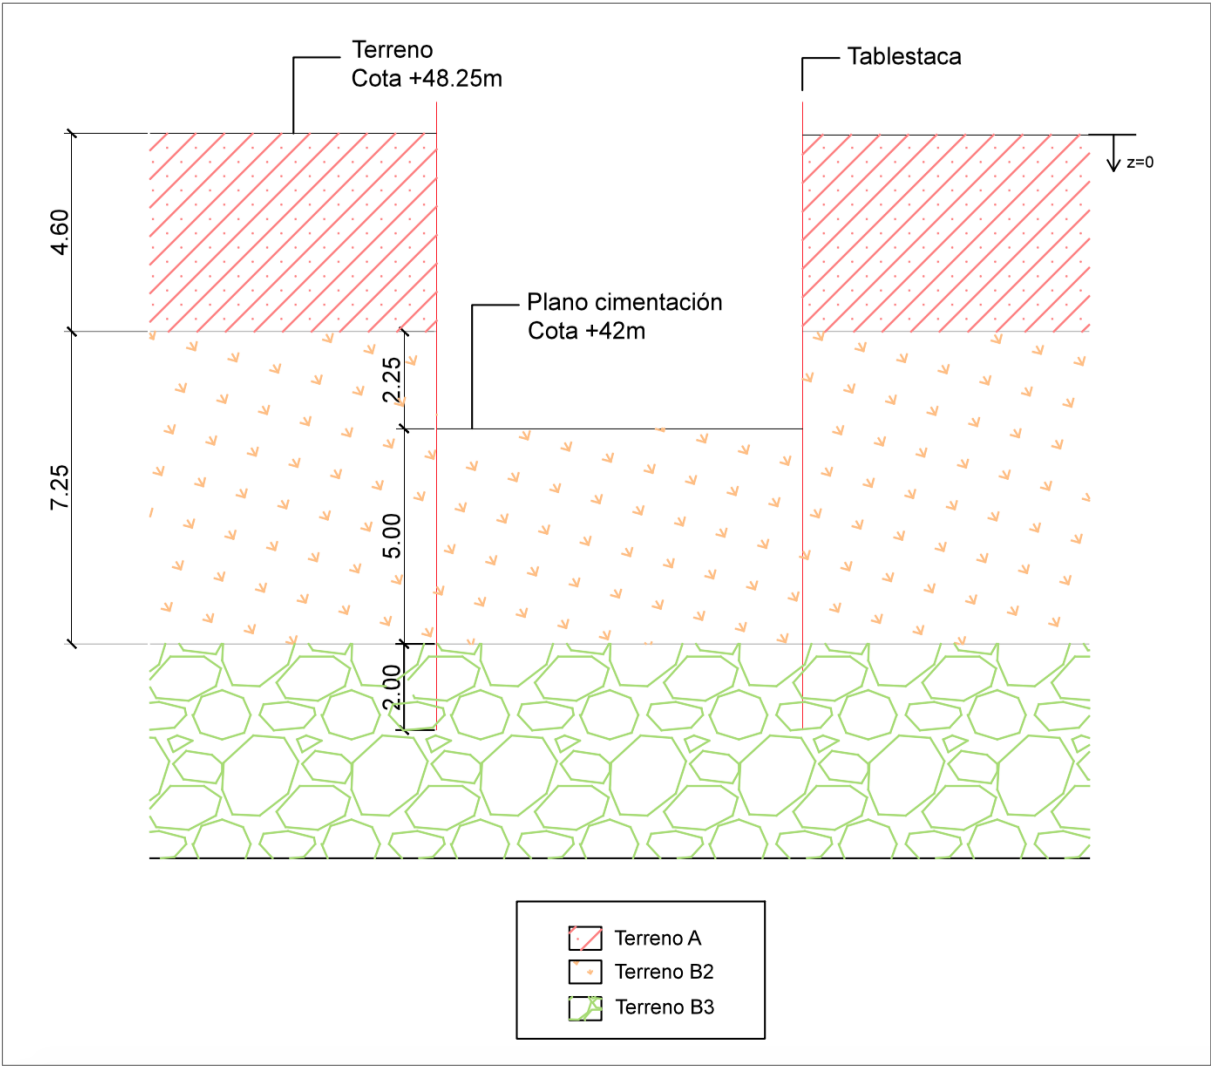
Terreno en el estribo sur para excavación con acodalamiento.
